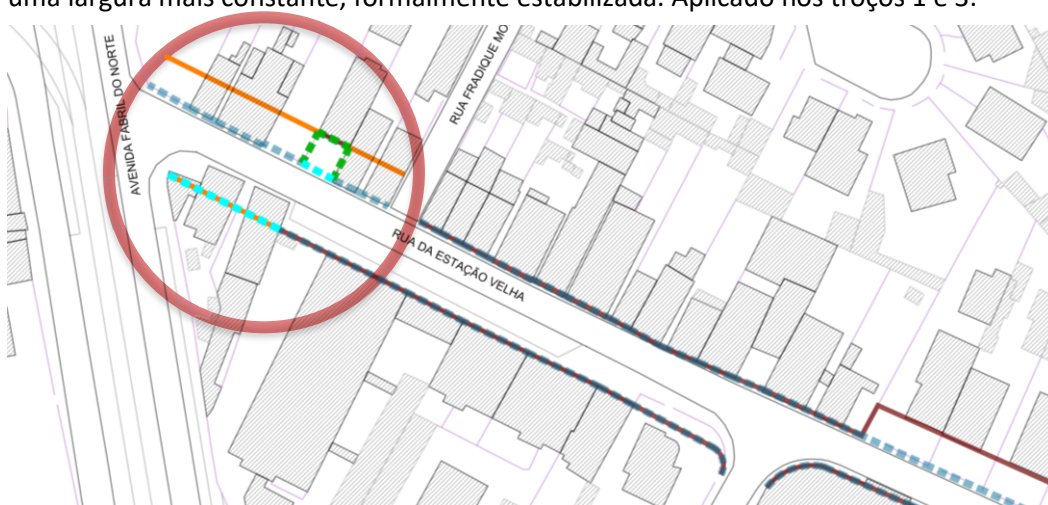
Exemplo da aplicação do princípio de Estabilização da Forma do Arruamento.
